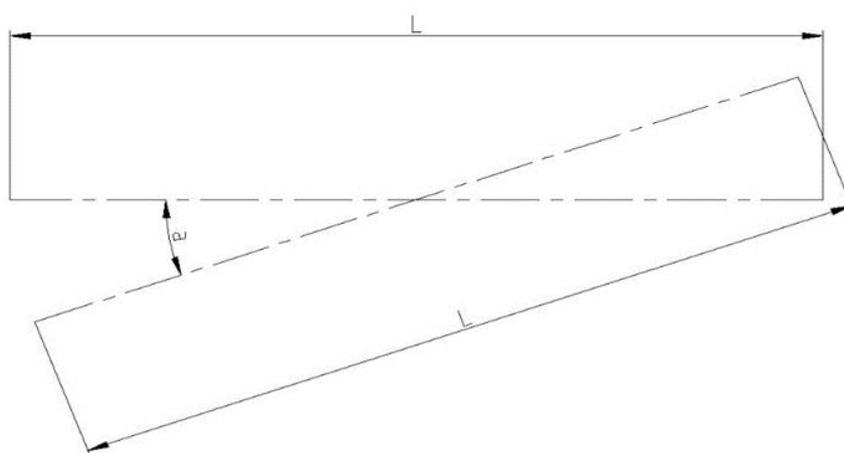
平移型平交道岔线型(尺寸单位: mm)
